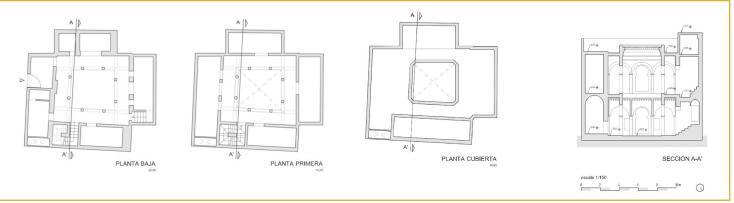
Plantas y corte de la casa dar Ben Abdeluahab (fuente: Los autores).
